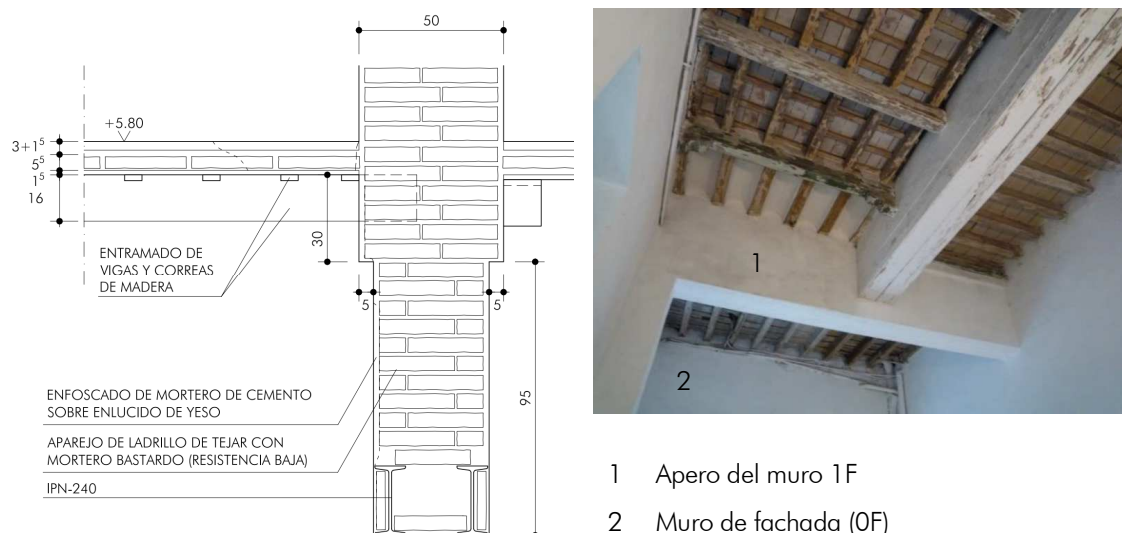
Sección constructiva del apeo del muro 1F a cota +4,20 m y fotografía.
